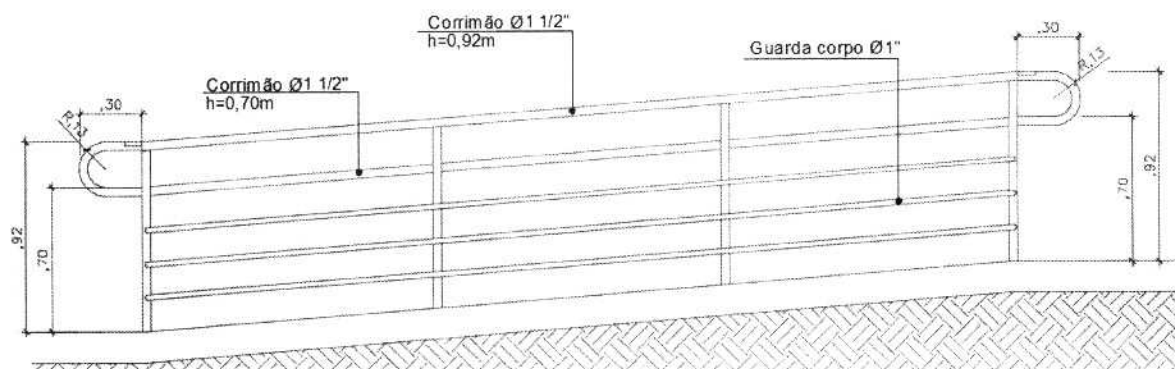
Detalhe de corrimão e guarda corpo em rampas externas
